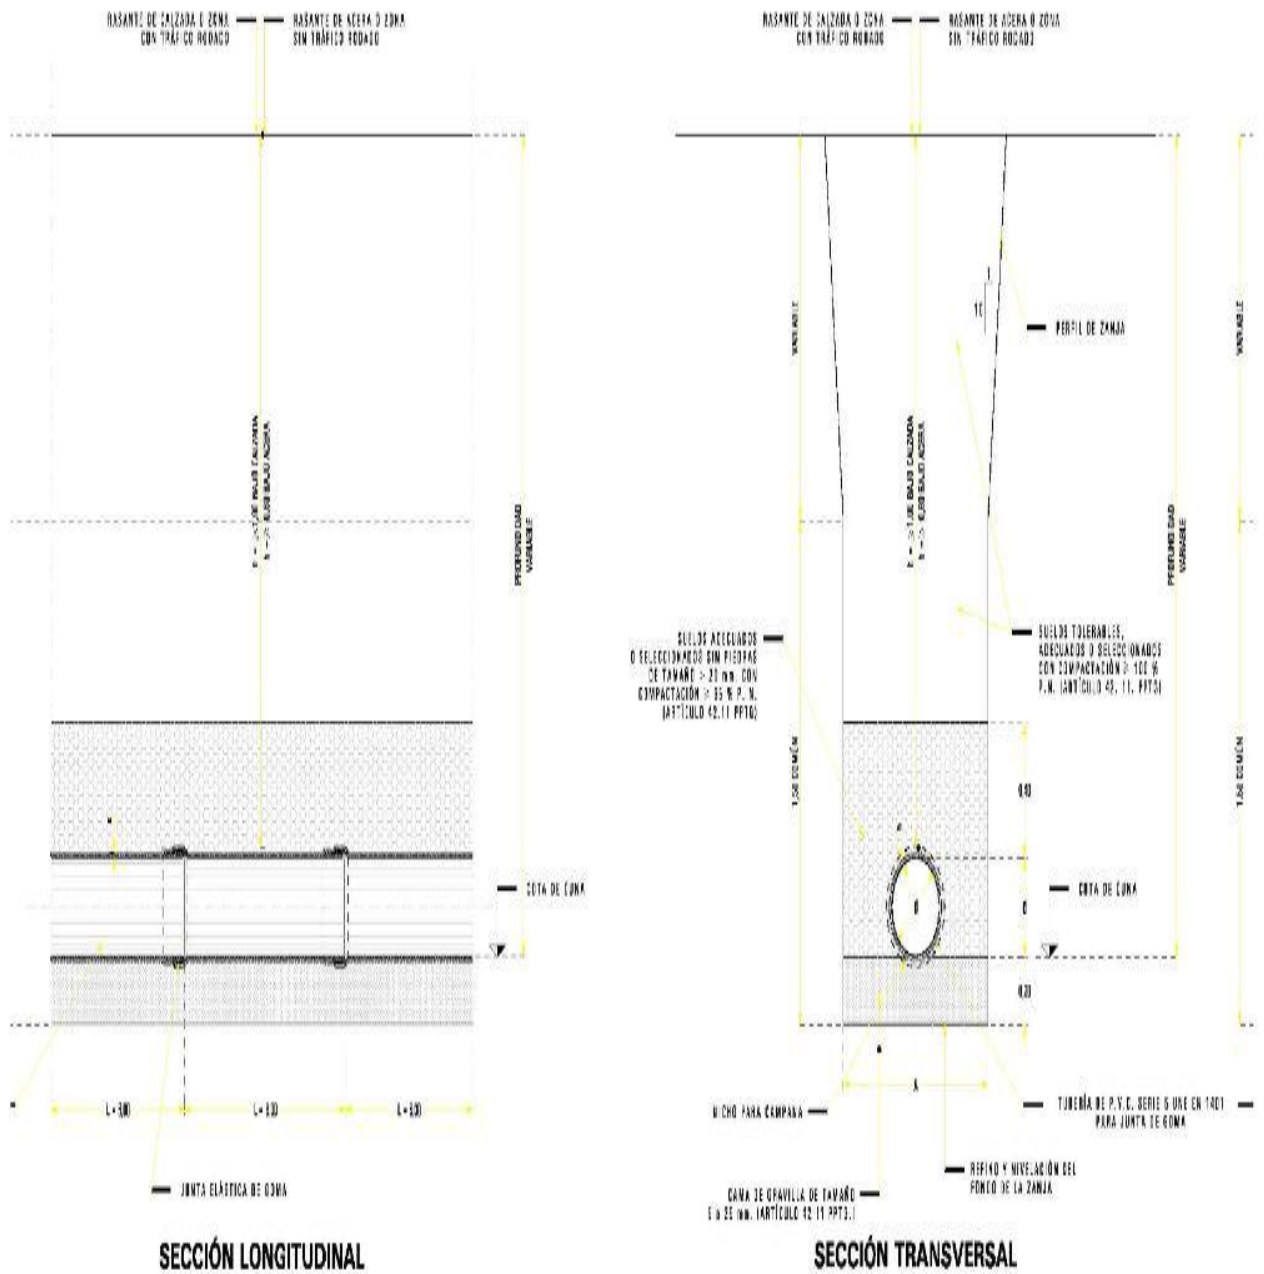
Plano de la sección transversal y longitudinal del alcantarillado.
